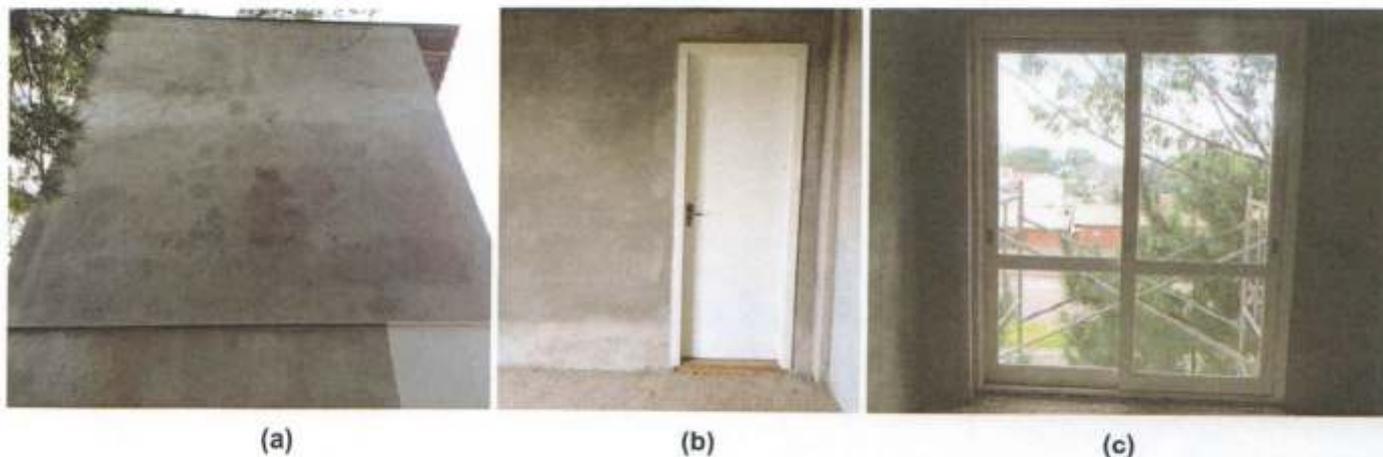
(a) - Vista exterior da fachada ensaiada; (b) – Porta interna; (c) Porta janela adjacente
